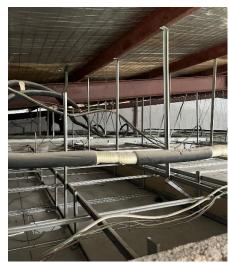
Installasi Listrik Departemen CNC Milling
